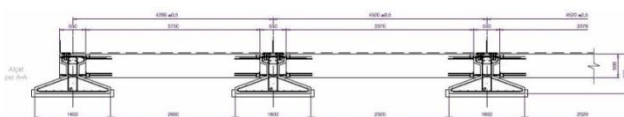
Sección vertical de la cimentación prefabricada del sistema Compact Habit®
